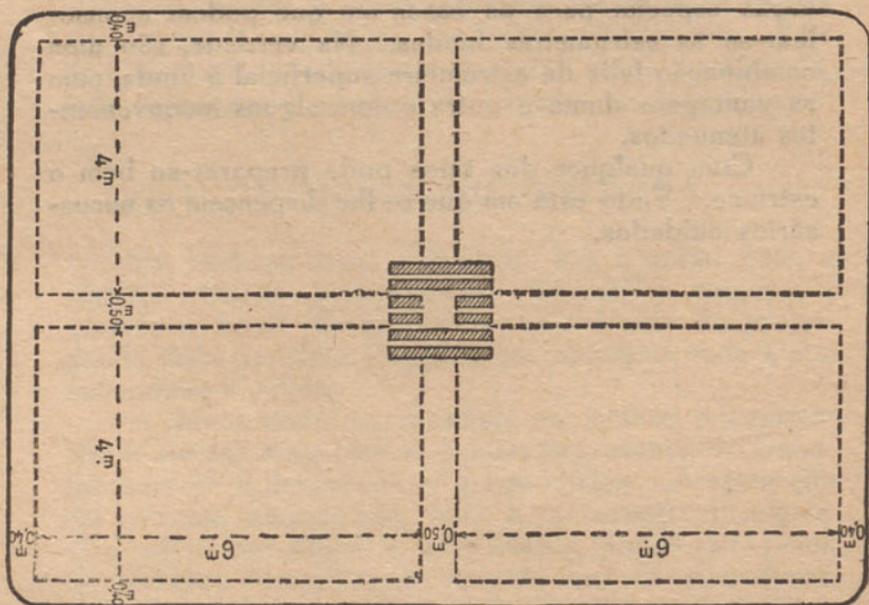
Planta da estrumeira superficial côncava, de cisterna ao centro — Ver figura 9
